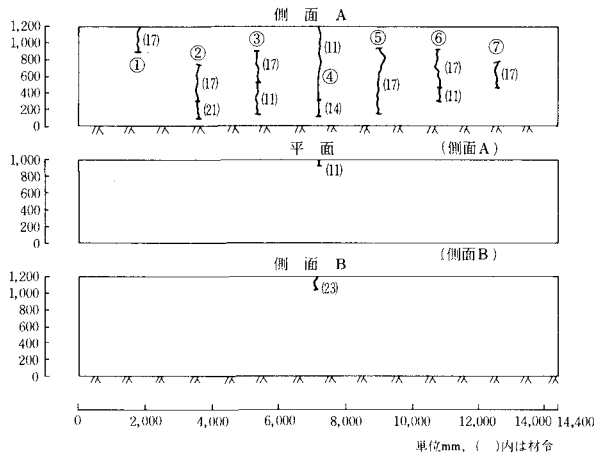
普通コンクリート試験体のひびわれ発生状況
